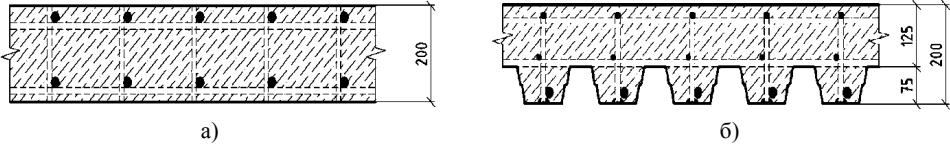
Переріз розглянутого перекриття: а) – монолітне залізобетонне безбалкове перекриття; б) – монолітне перекриття з використанням профлиста як зовнішньої арматури
